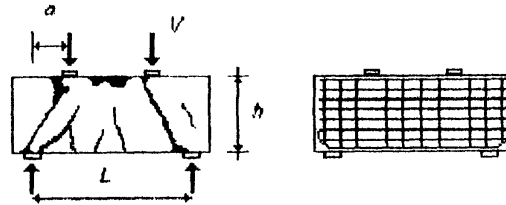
, Falla por cortante en vigas diafragma. Red de refuerzo vertical y horizontal.
